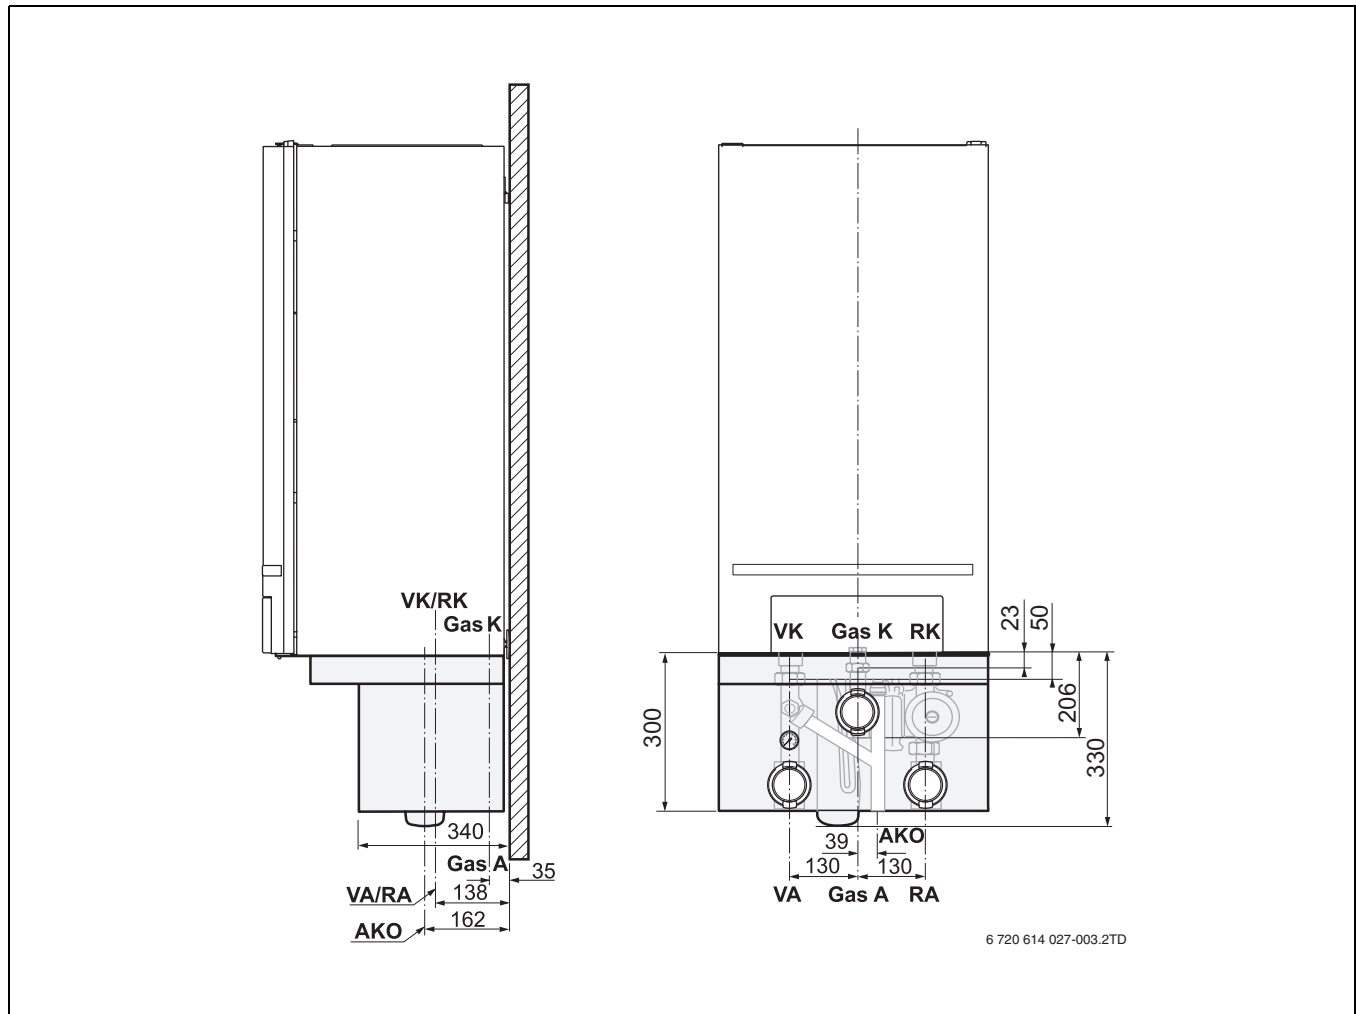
Dimensioni e attacchi con il gruppo di collegamento [mm]
